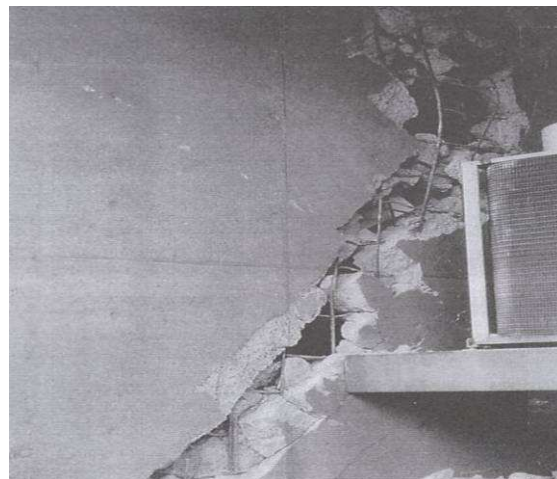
Kobé 1995 – Fissure de cisaillement (type brèche) d'un voile de contreventement d'un bâtiment de 12 niveaux non effondré.
